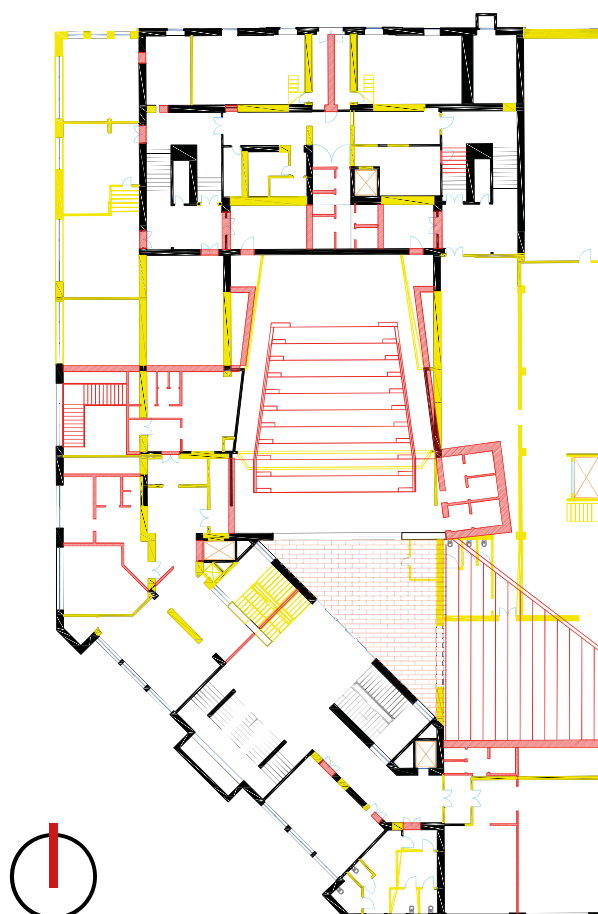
Schema demolizione costruzione, confronto Piano Seminterrato tra SdF e Progetto
